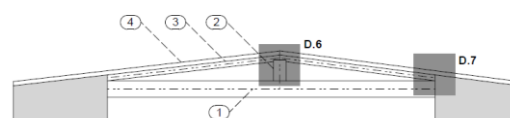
Detalle de la cubierta añadida en trabajos posteriores de la aceña.
